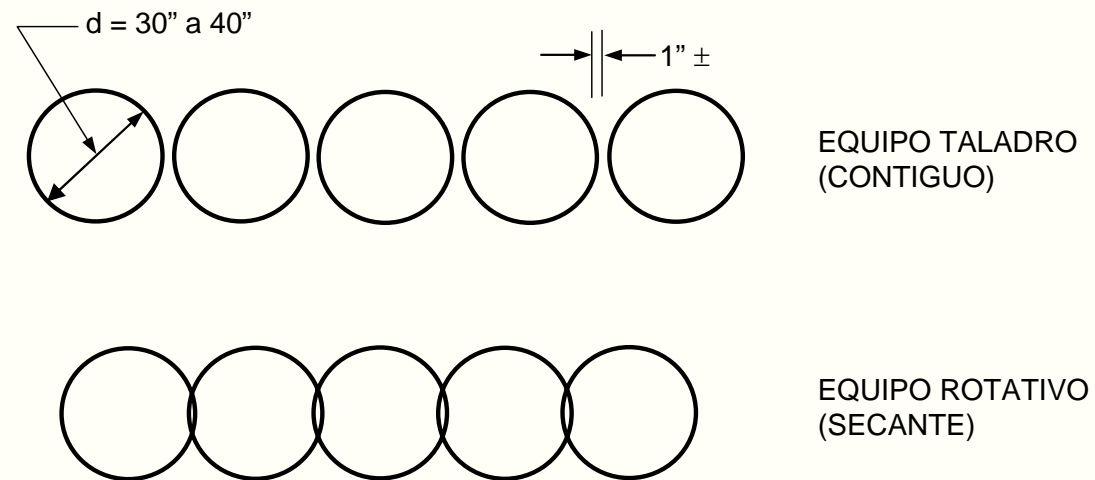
CONSTRUCCION DE PANTALLA DE CONCRETO
